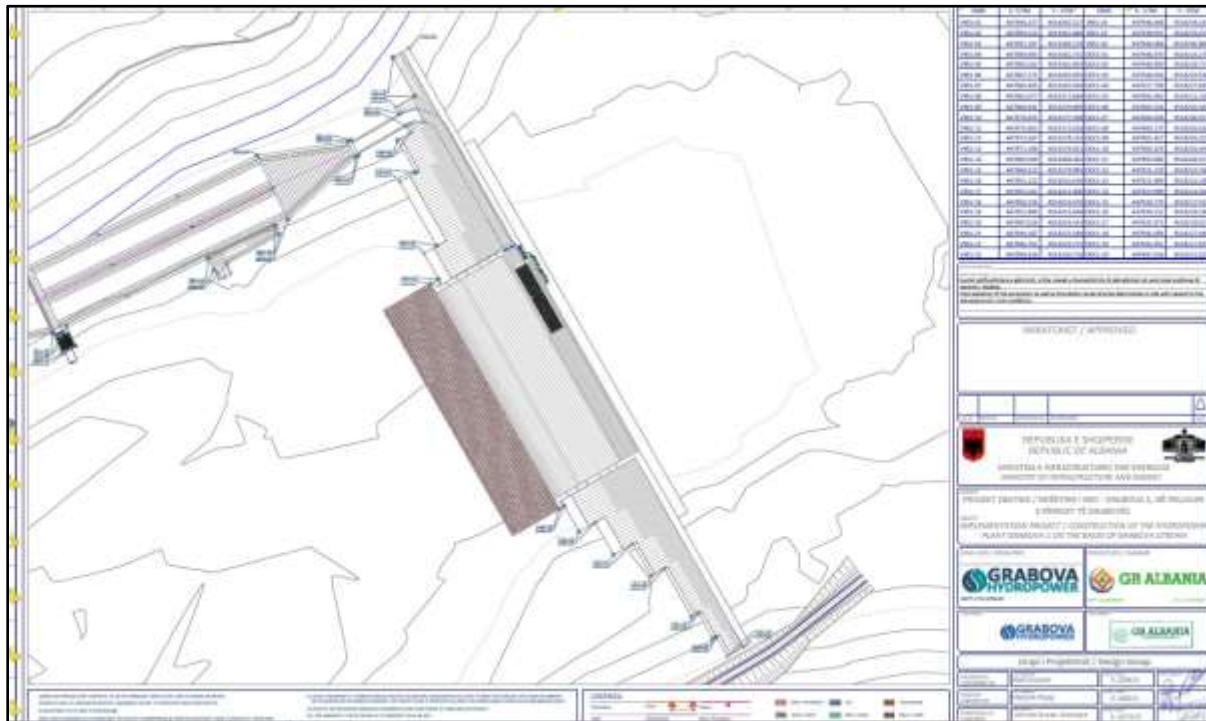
Planimetria e V.M1 dhe Dekantuesit
